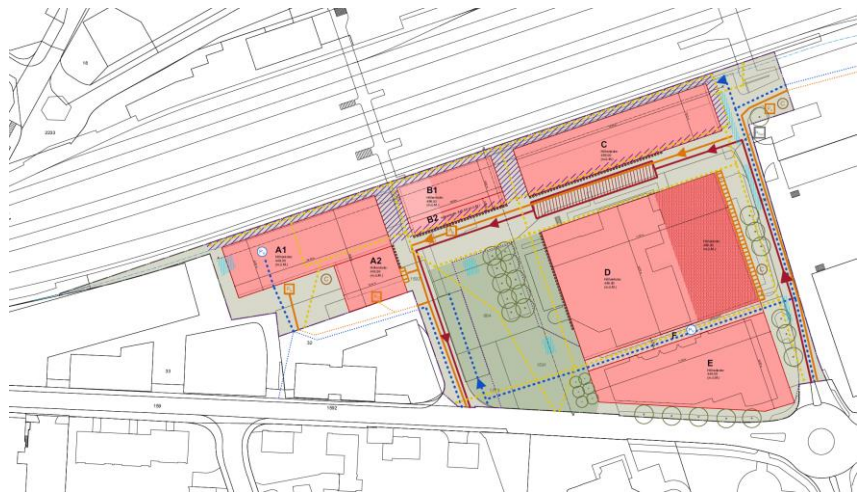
Ausschnitt Bebauungsplan Bahnhof Süd
